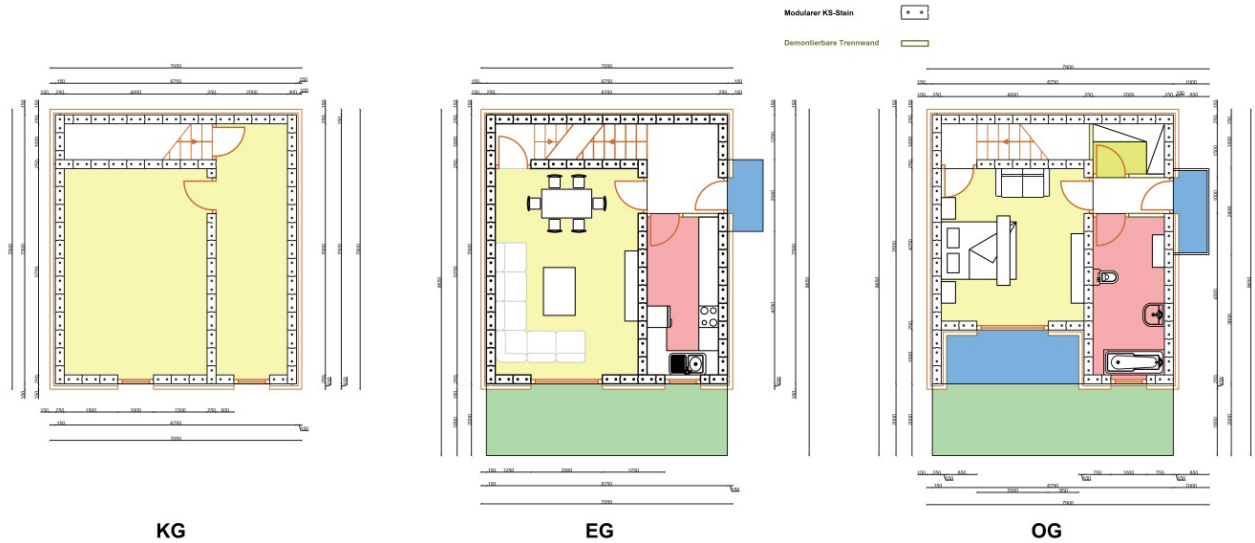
Grundrissgestaltung Experimentalbau - ReDeMaM
